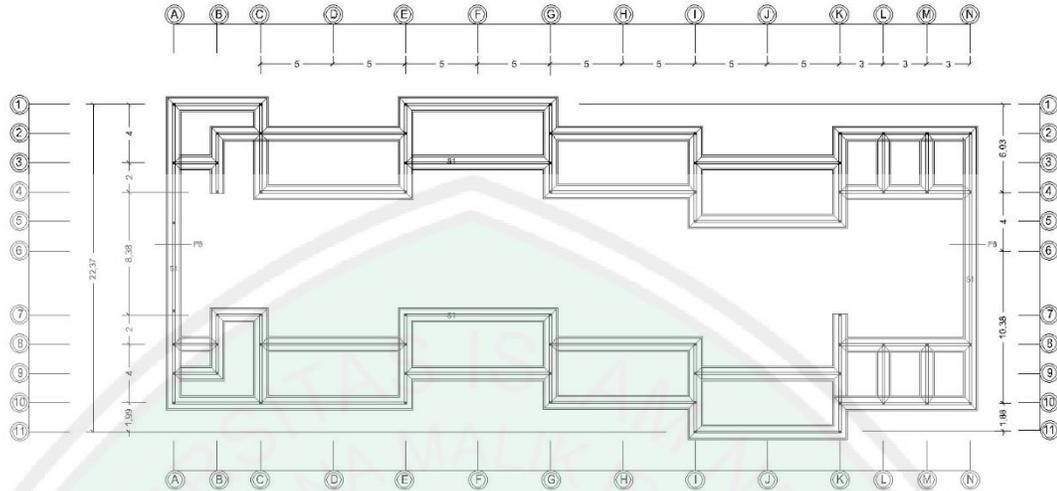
Pondasi Telapak Lajur Batu Kali dan Dilatasi
